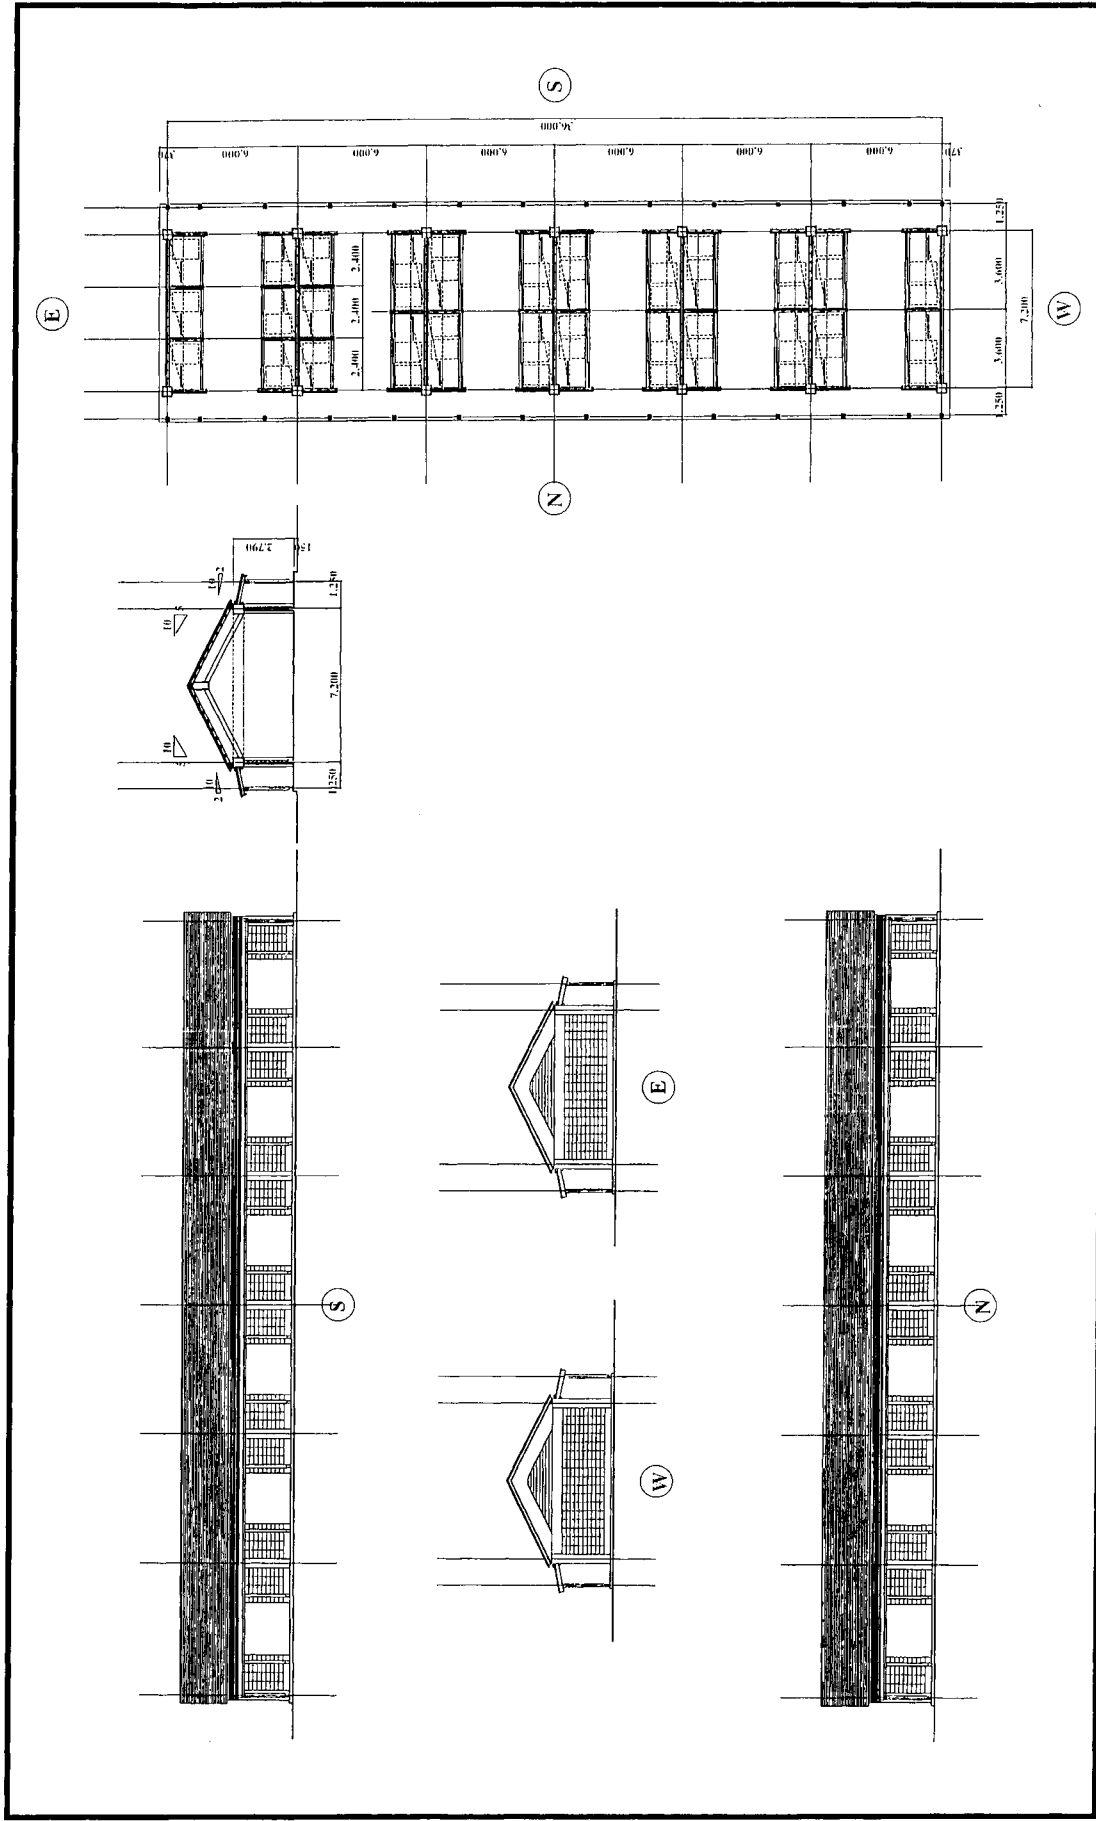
(1) 渔民用渔具仓库平面·立面图
